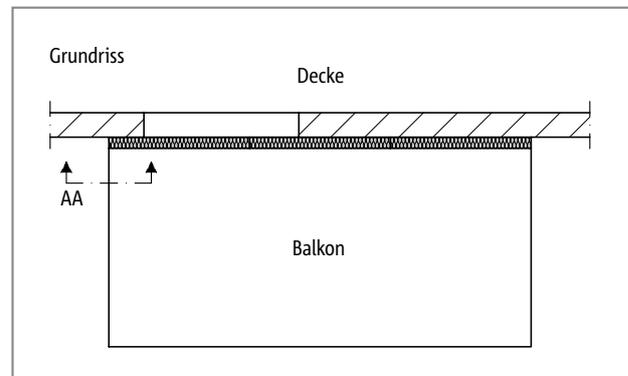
Schöck Isokorb® RT Typ KL: Balkon frei auskragend
